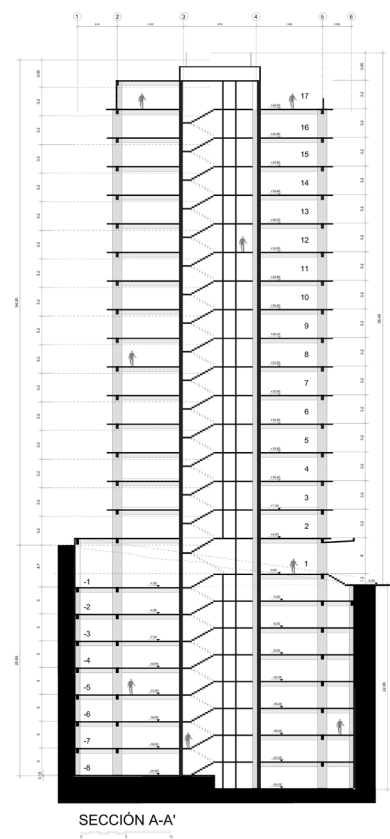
La sección muestra la simetría del sistema estructural, con el centro reforzado con los muros de corte.
